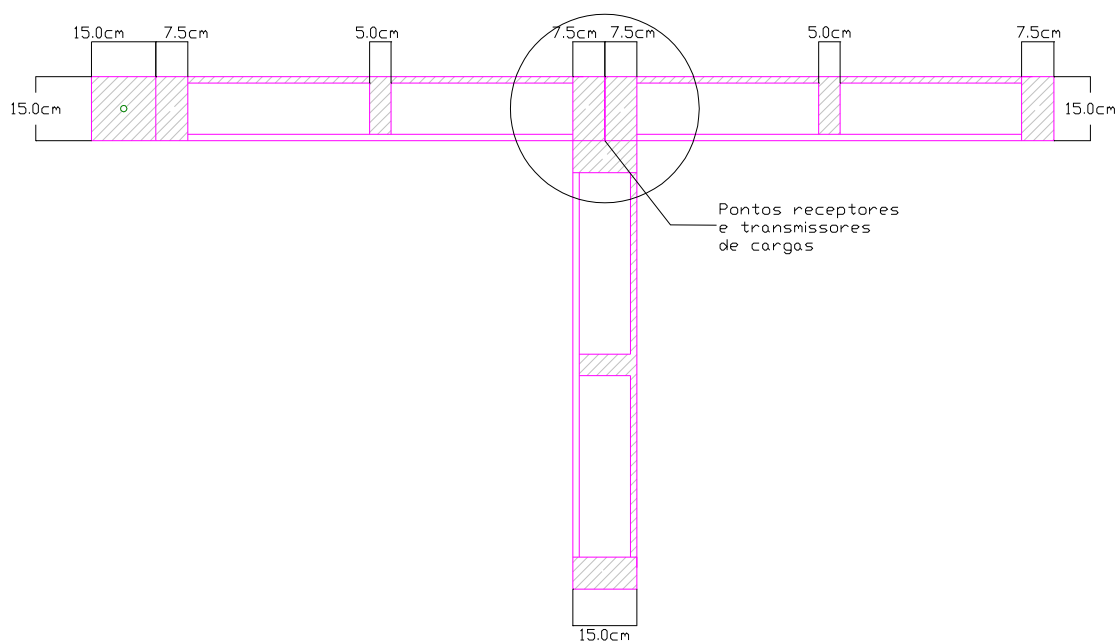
Conexões de painéis com paredes intermédias do sistema construtivo definitivo.
